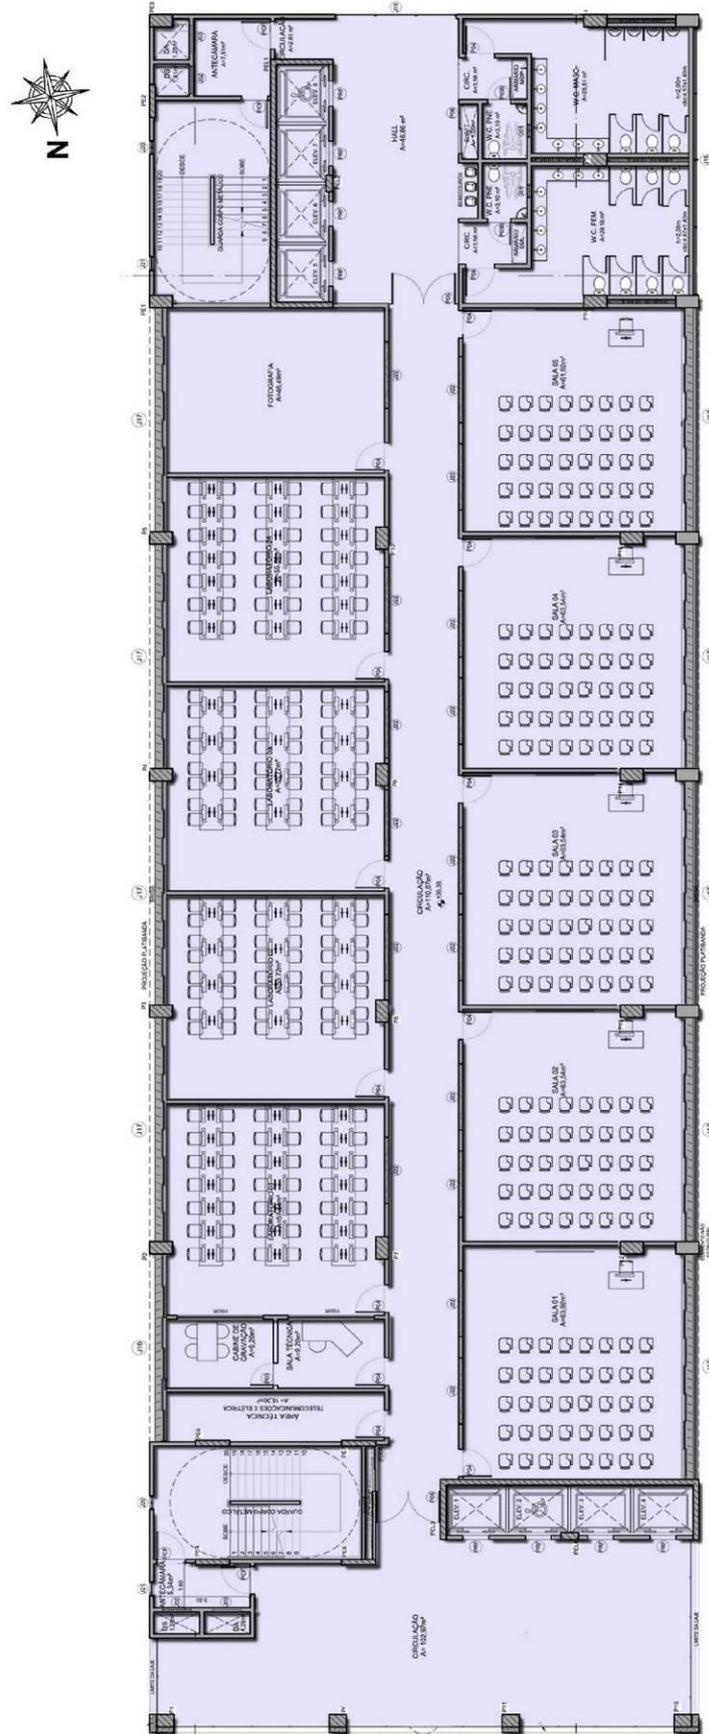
Representação em planta baixa do Pavimento de Salas de Aula.
